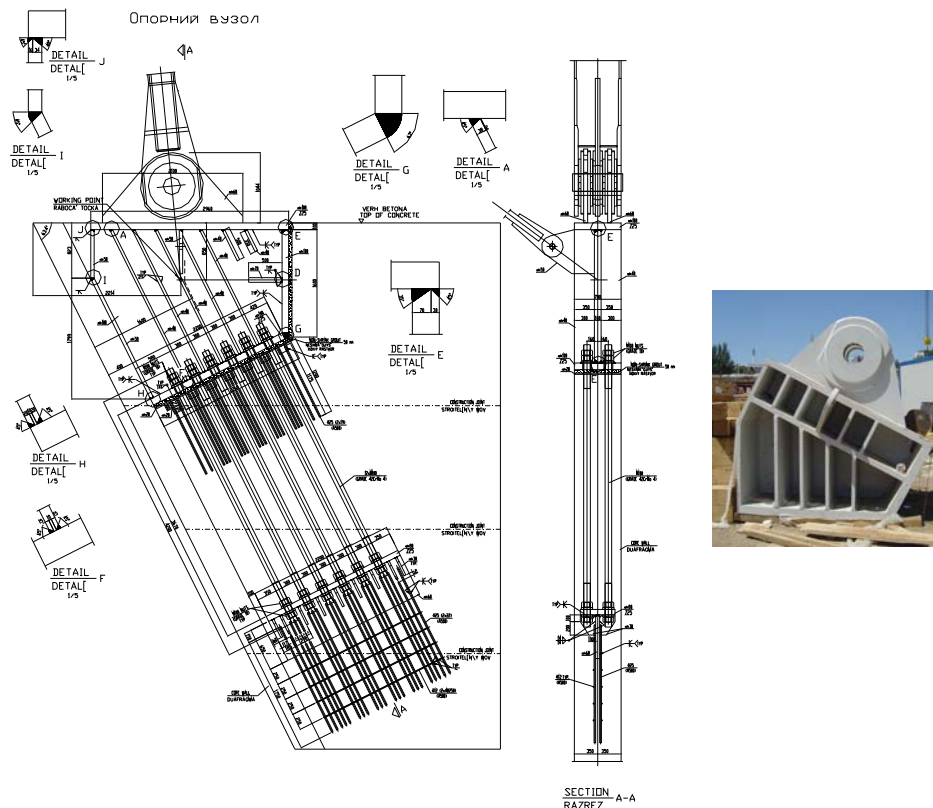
Чертеж опорного узла радиальной стропильной фермы.
